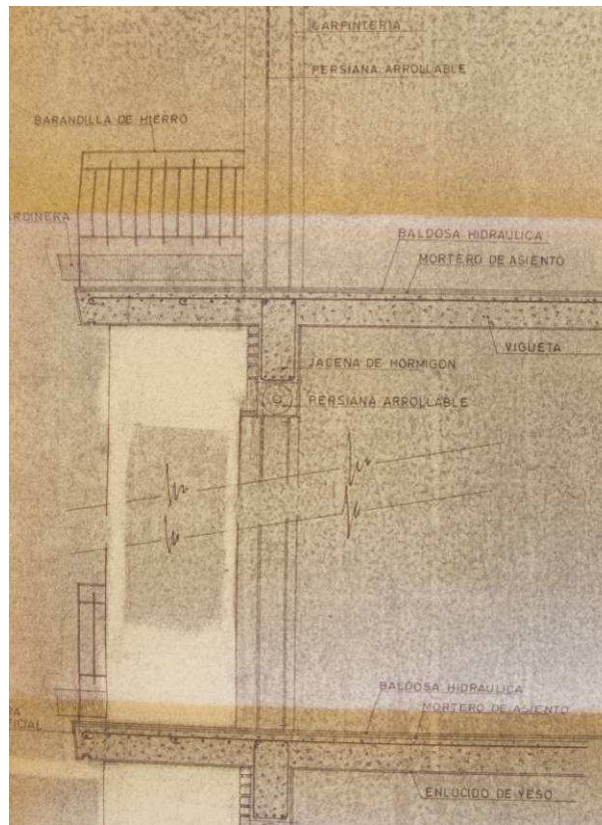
Detalle constructivo de fachada. Edificio 88C.019, 1966
